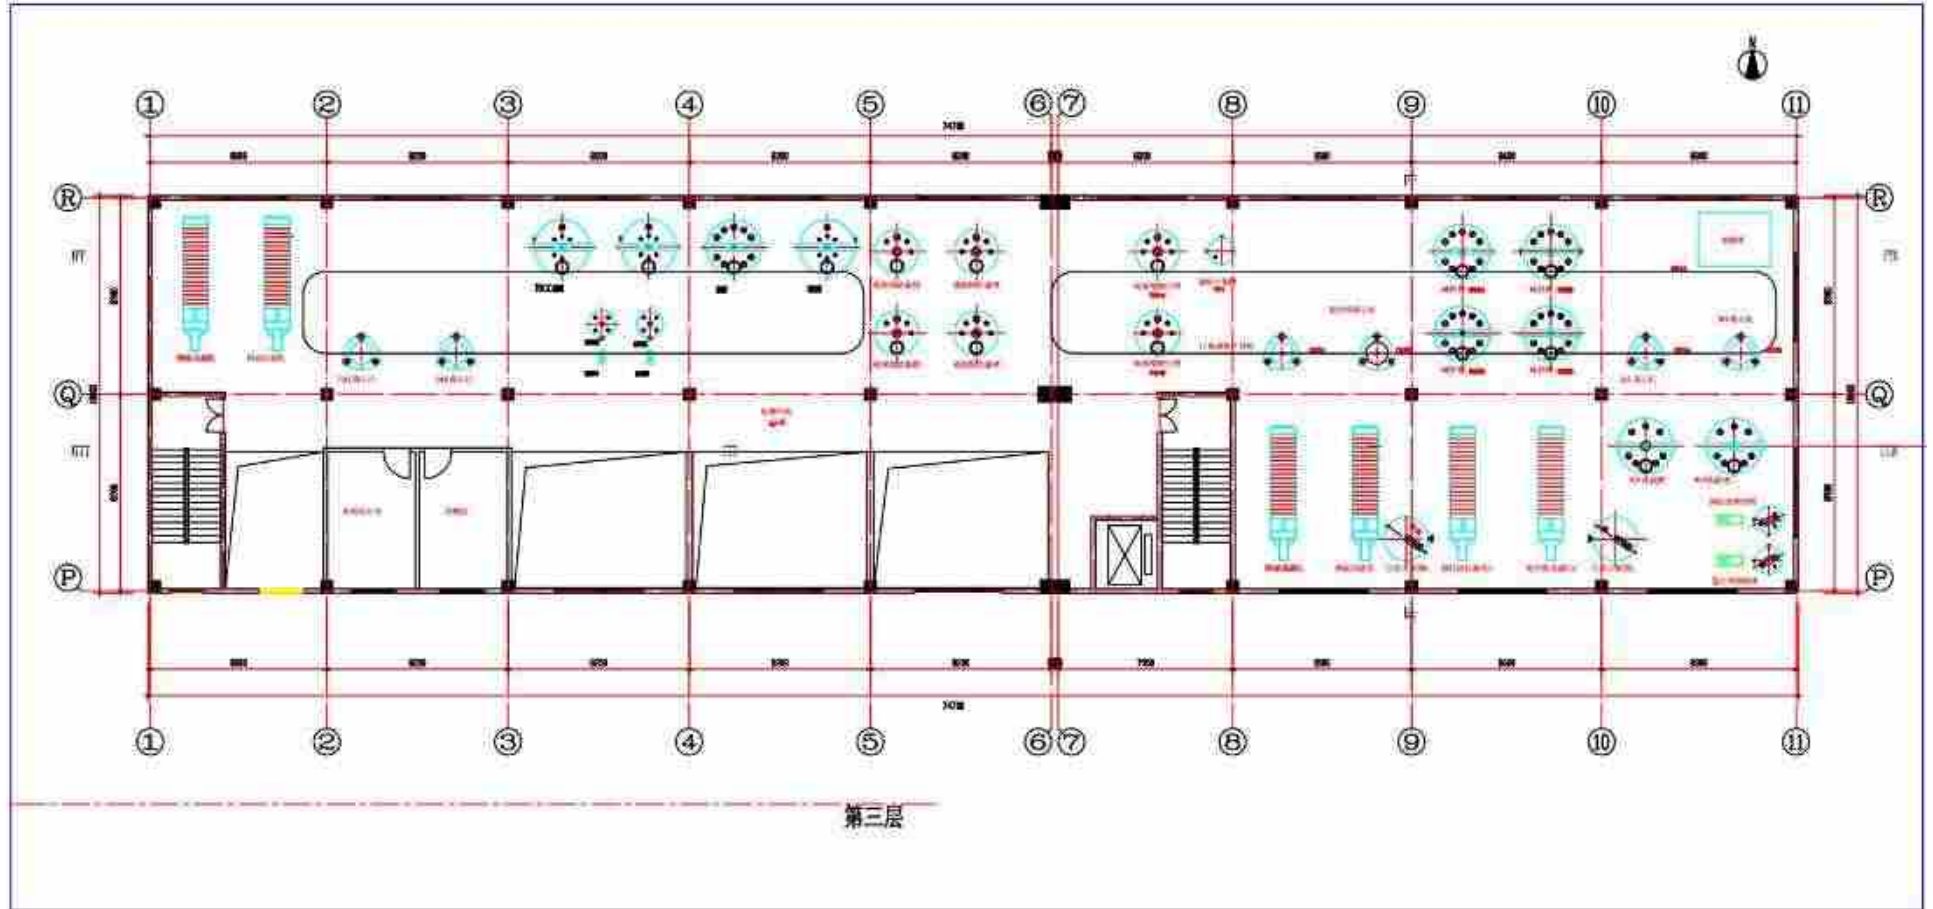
(3) 本次改扩建后 6# 厂房 3 层平面布置图
